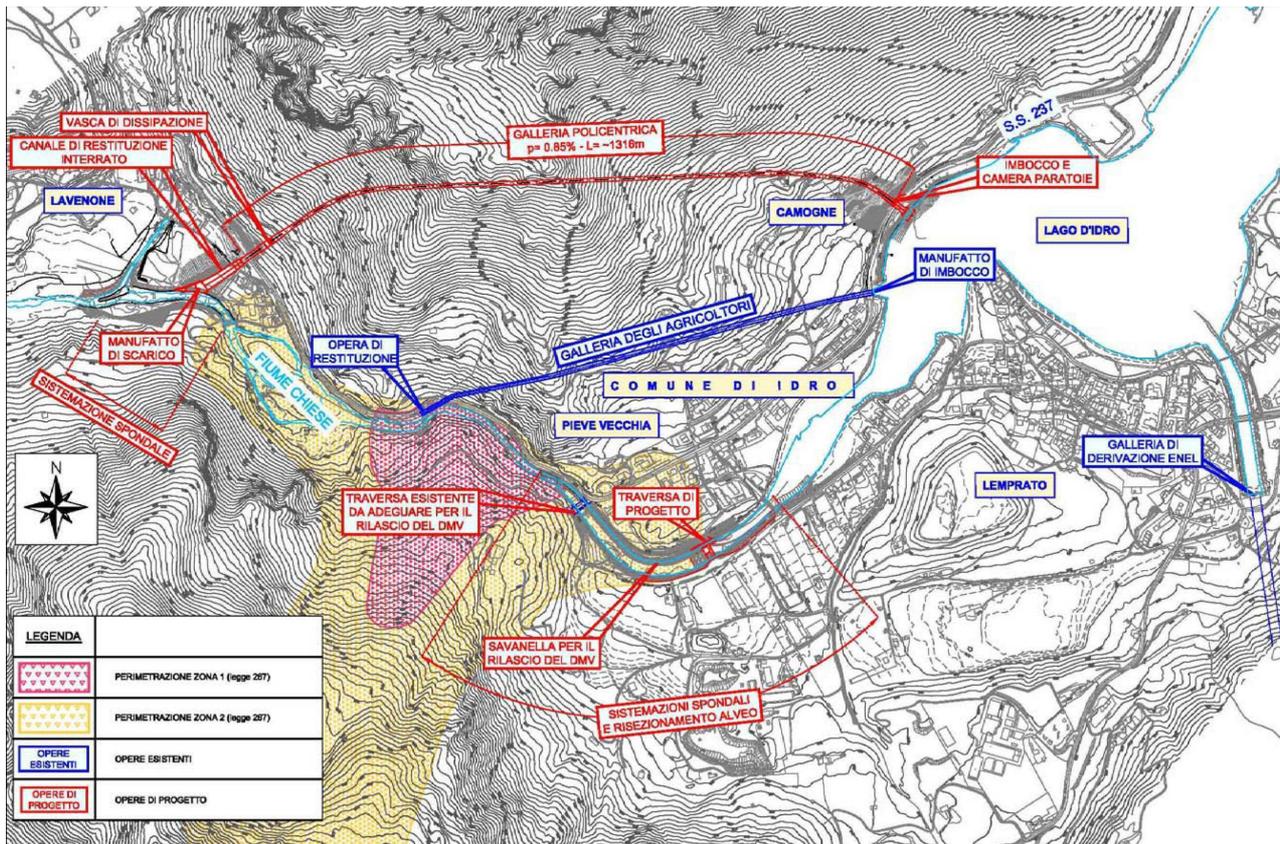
planimetria dello stato di progetto (prima versione) in blu le opere esistenti, in rosso le opere di progetto.
